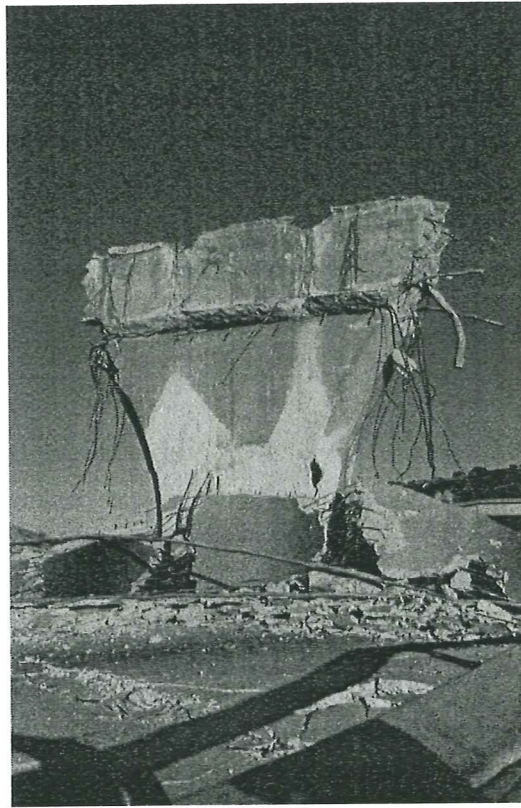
Detalle de columna número tres, (Priestley *et al.*, 1994).
